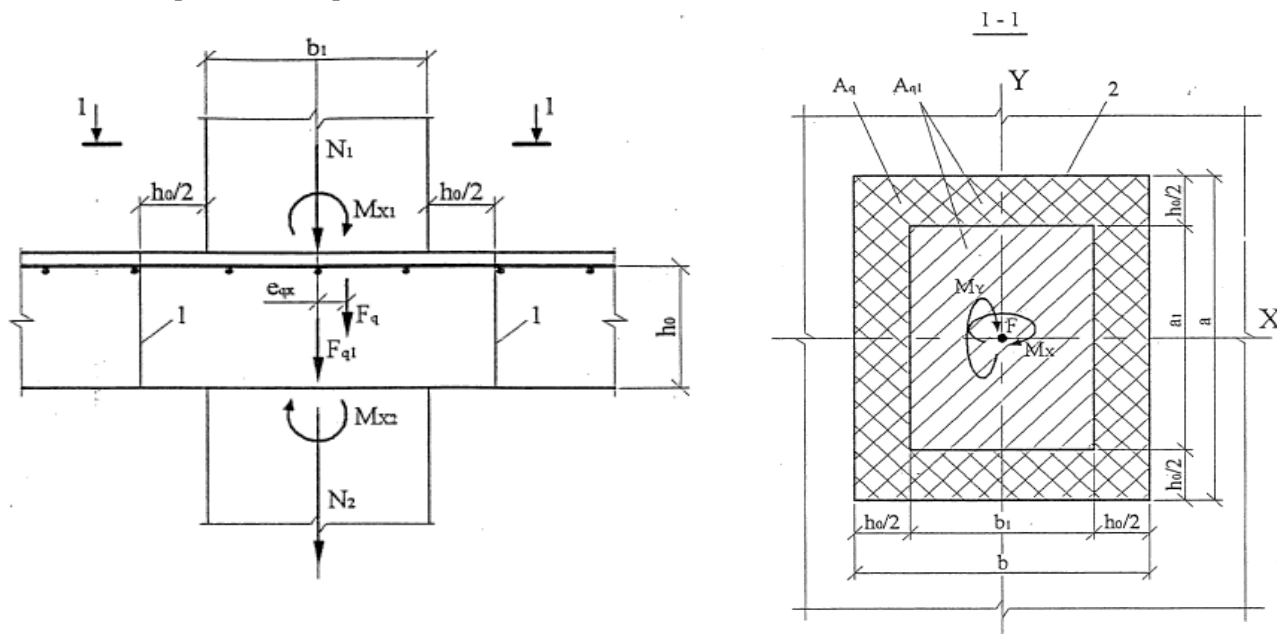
Расчетные схемы к расчету плиты перекрытия на продавливание.
